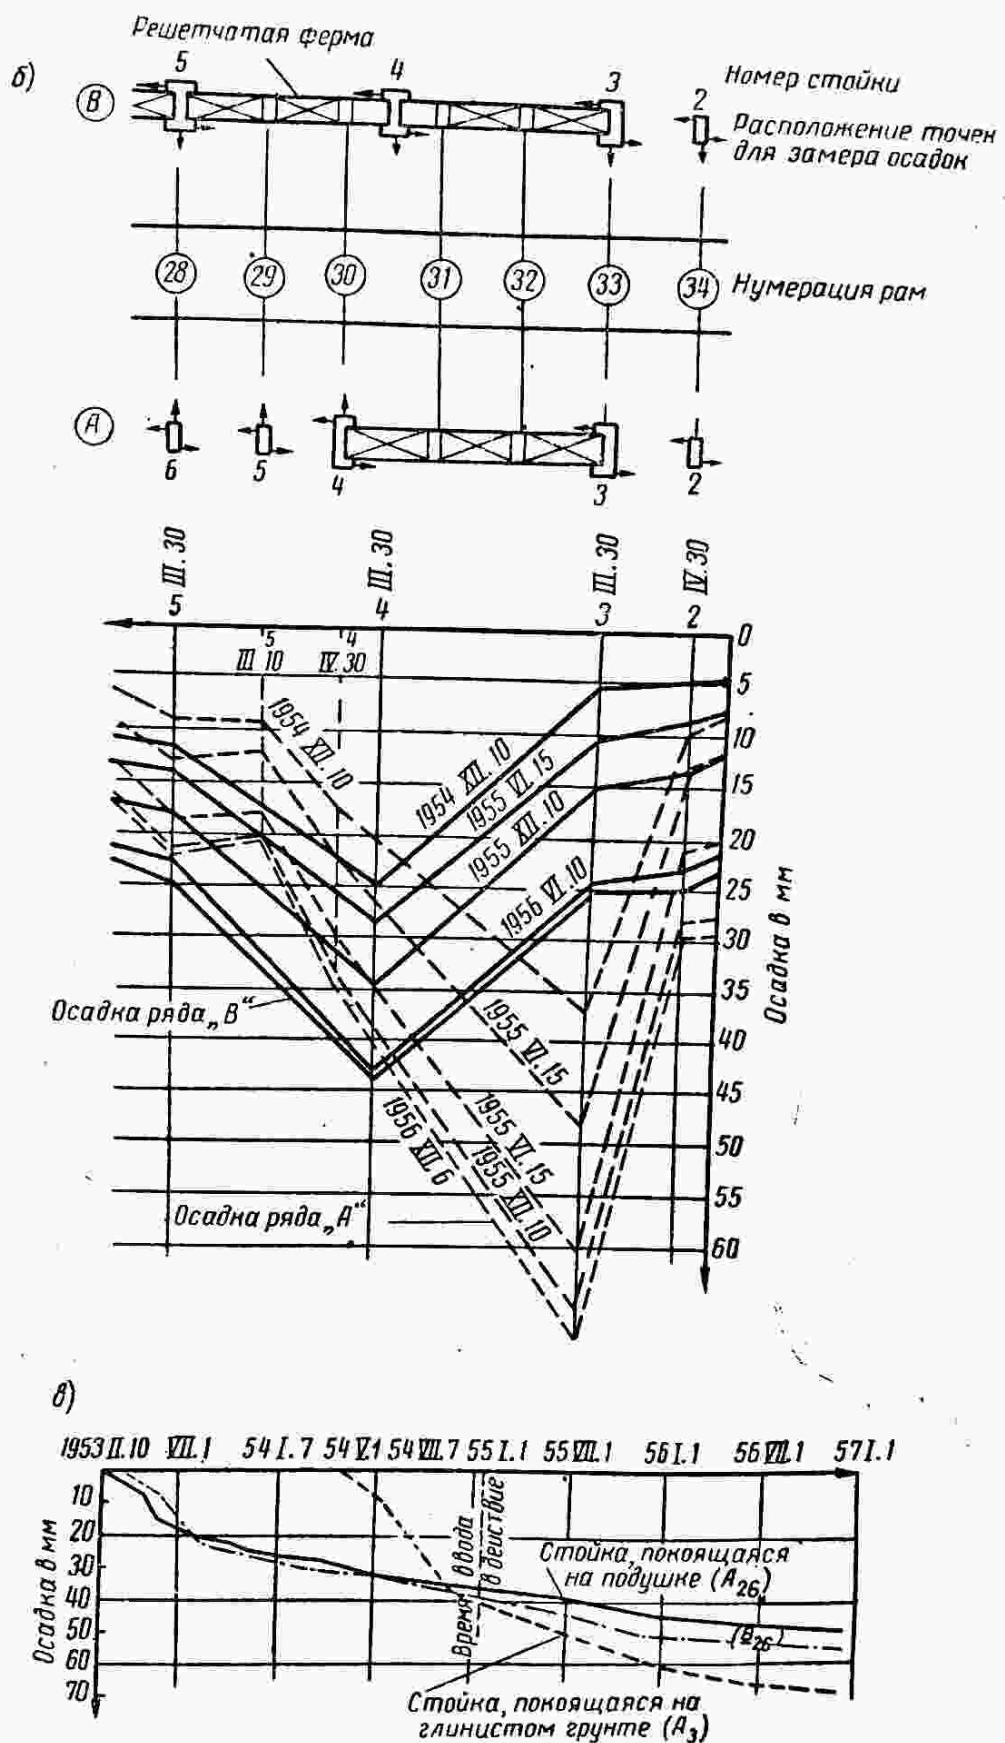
б, в. Осадка фундаментов стоек здания прокатного цеха и ее протекание во времени
